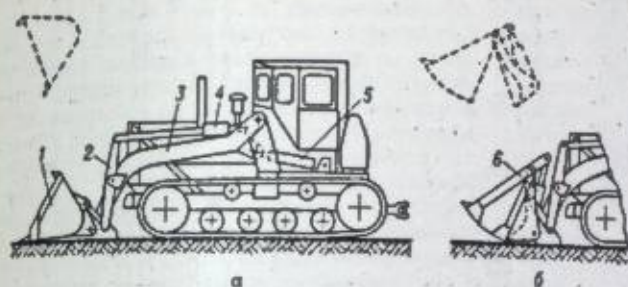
Одноковшовый погрузчик с передней разгрузкой (а — с обычным ковшом; б — с двухчелюстным ковшом): 1 — ковш; 2 — рычаги для поворота ковша; 3 — стрела; 4 — гидроцилиндр для поворота ковша на стреле; 5 — гидроцилиндр для подъема стрелы; 6 — гидроцилиндр для открывания передней челюсти ковша.
